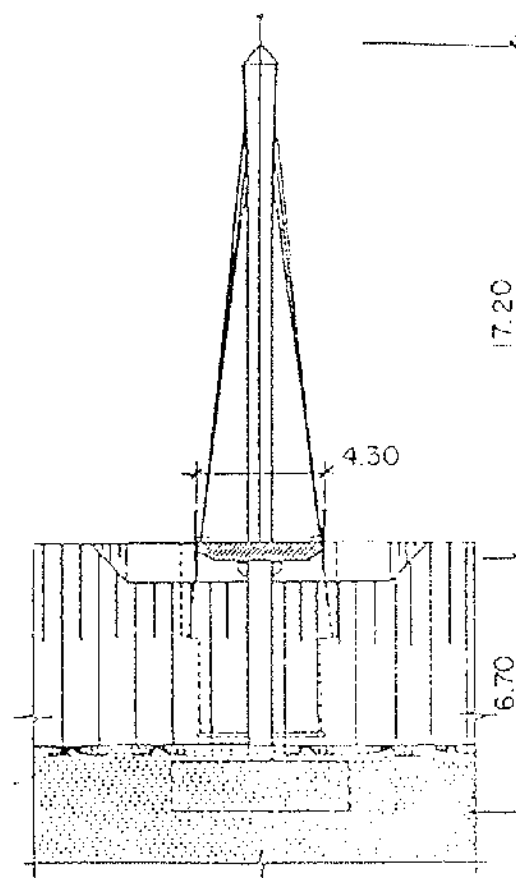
Sección Transversal de la Pasarela del Mazo.
